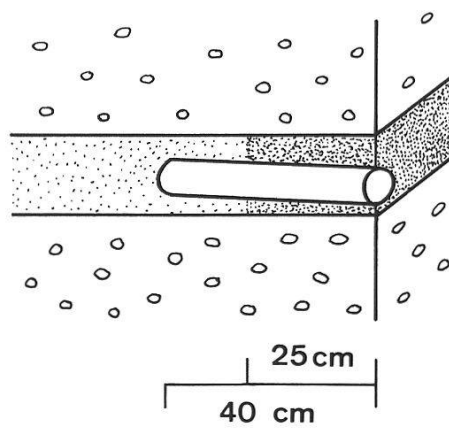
Schnitt durch eine vorn verfestigte Weichsandschicht mit eingelegtem Drainageröhrenstück.
